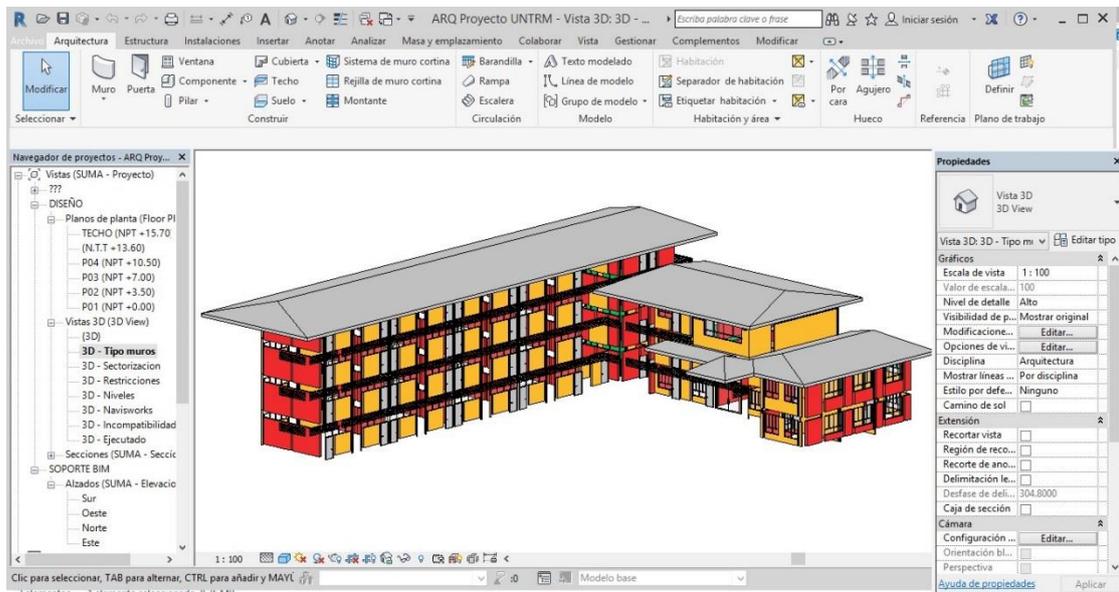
MODELADO – ALZADO O ELEVACION DE NIVELES
